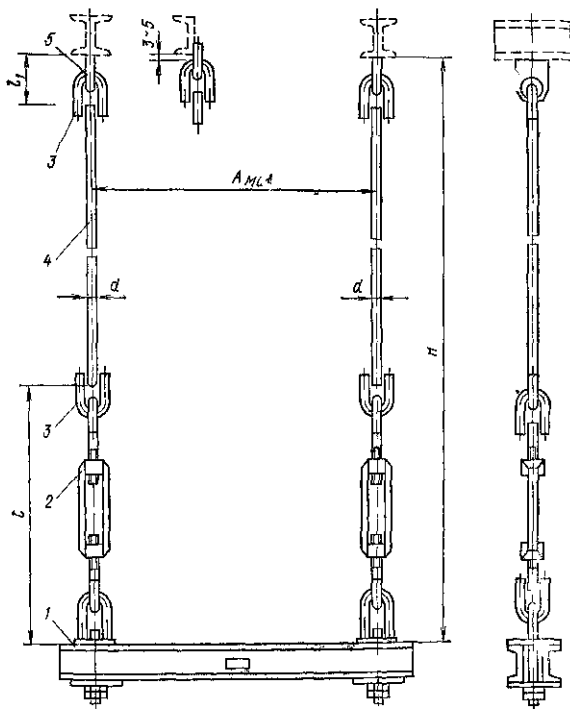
Подвеска с двумя тягами, регулируемыми муфтами и опорной балкой из швеллеров
